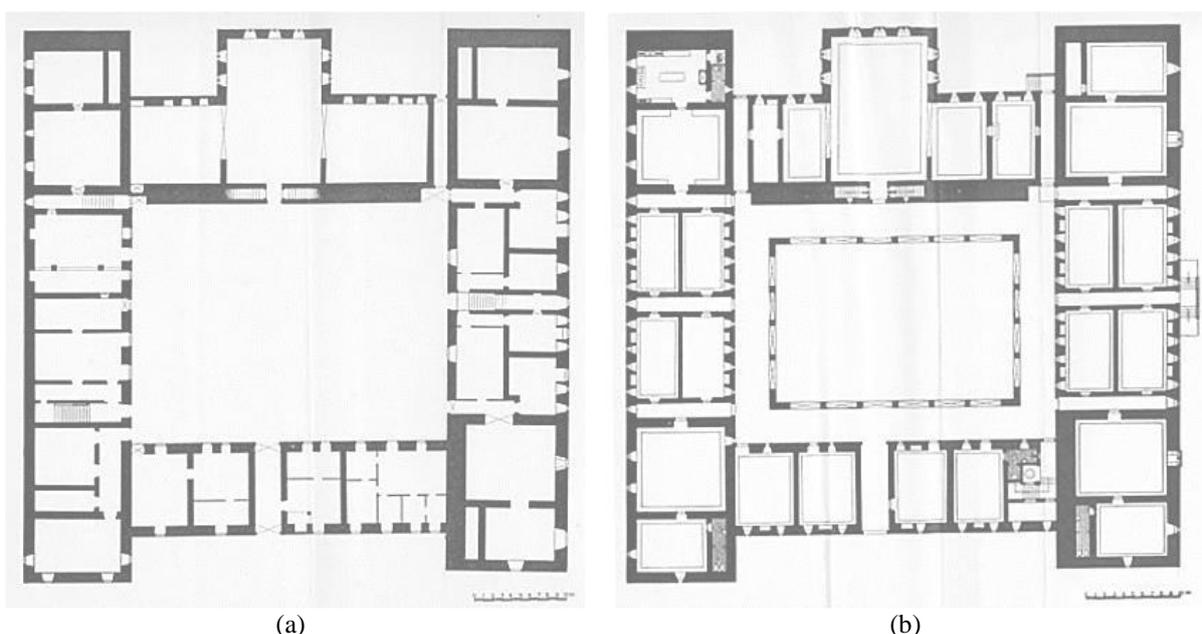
Planta térrea: (a) antes da restauração; (b) depois da restauração.
